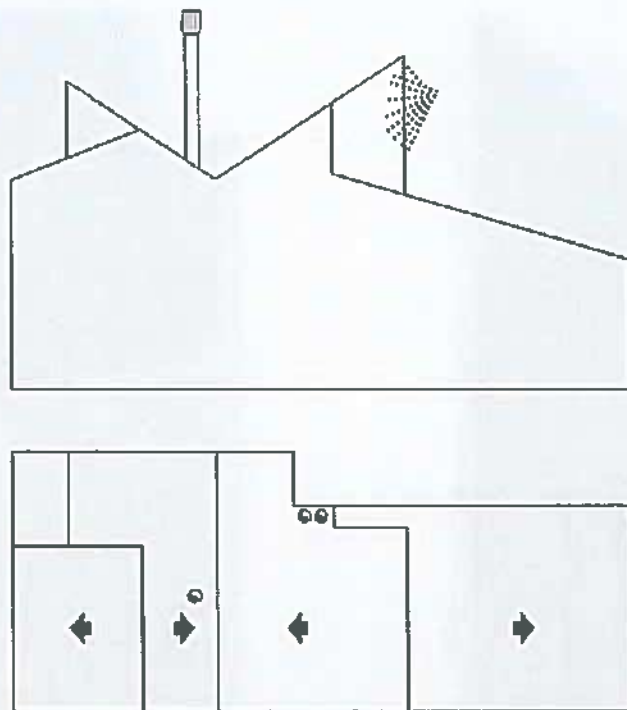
Esquema de cubiertas de la vivienda. Punto singular probado en fachada baño
